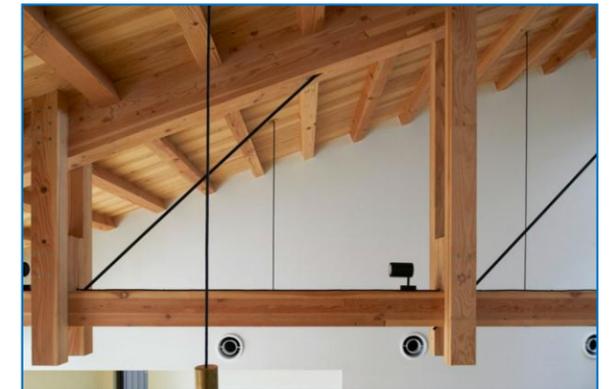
Detalle Fijación con cables tensoros de acero inoxidable. Fuente; Héctor Scerbo estructuras en madera
